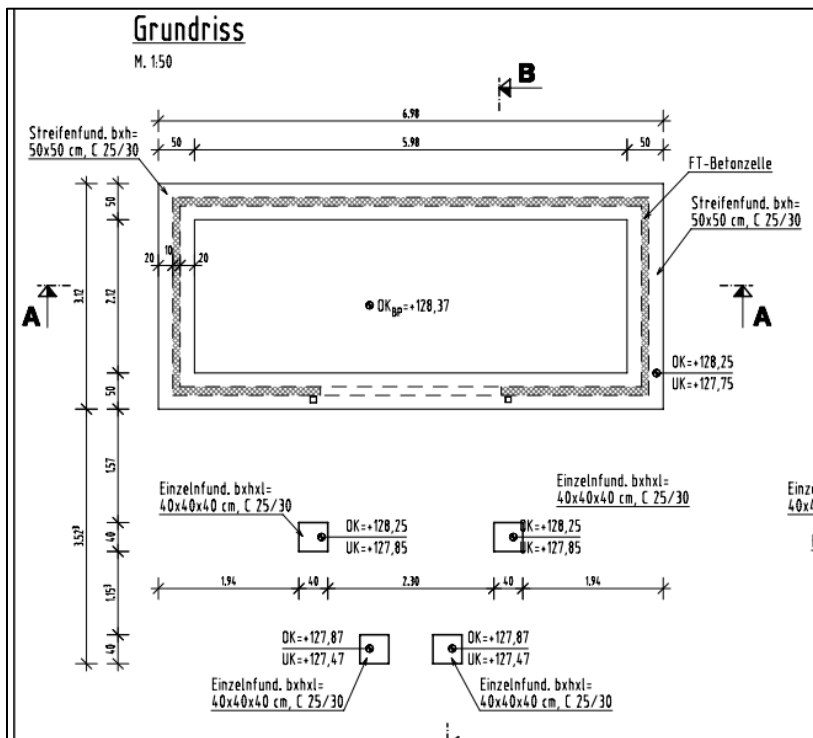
Grundriss Fundamente Raumzelle
